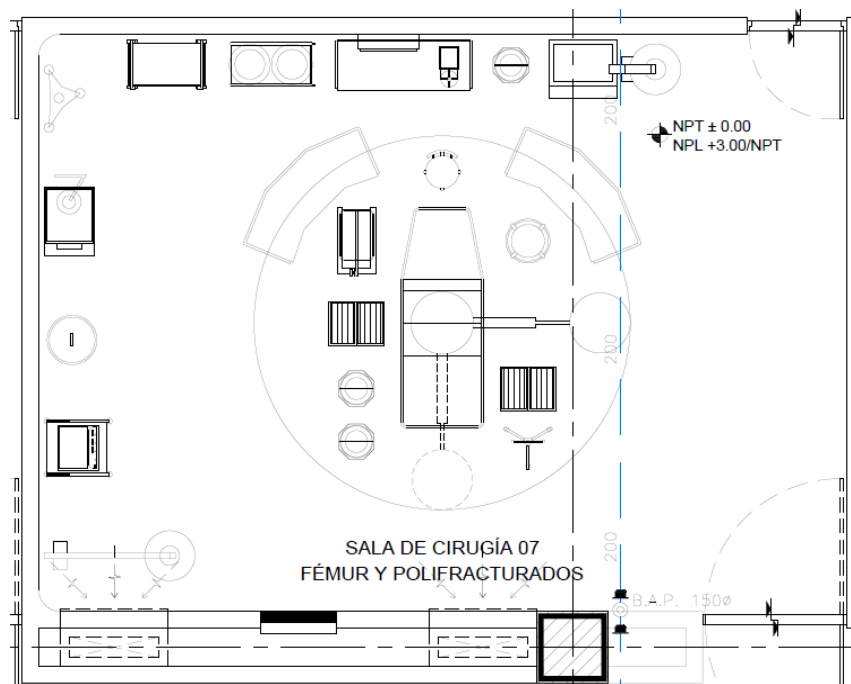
Extracto de plano de estado actual empatado con proyecto arquitectónico, se muestra como la instalación existente (azul) pasa sobre uno de los quirófanos que se propone construir.
